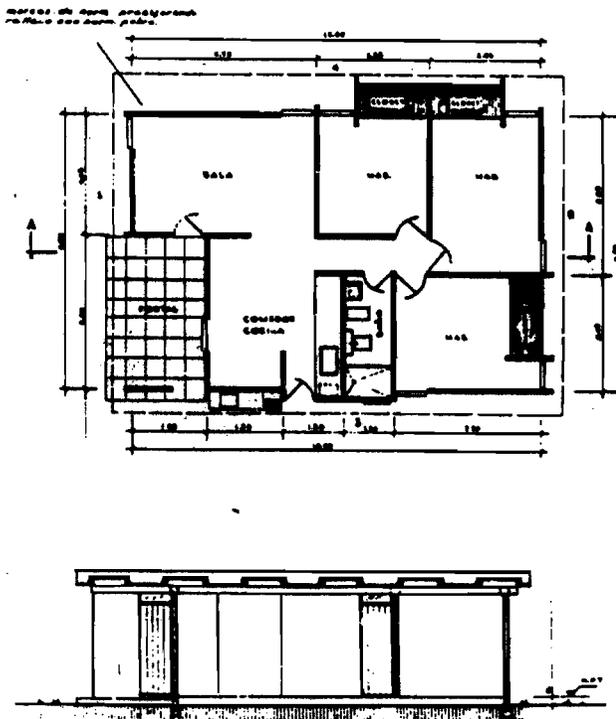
Viviendas para la erradicación de barrios insalubres. Arquitecto Manuel Gutiérrez.
